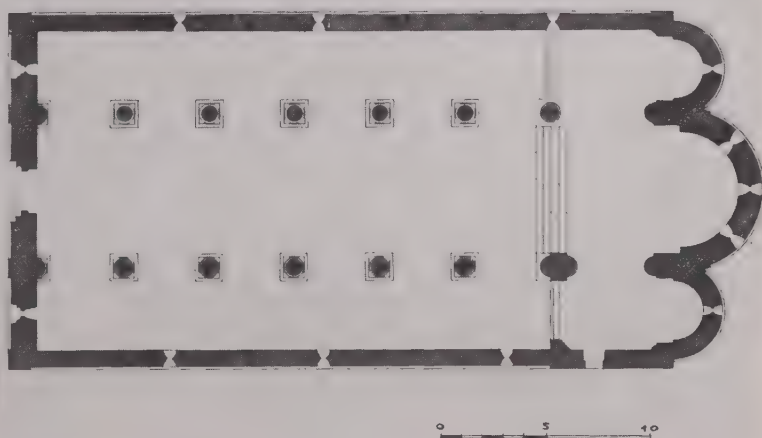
Pianta della chiesa liberata dalle sovrastrutture restituita allo stato originario
